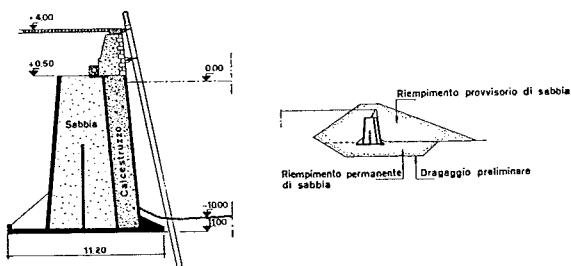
PORTO DI ROTTERDAM. Banchina nel bacino Waalhaven.
